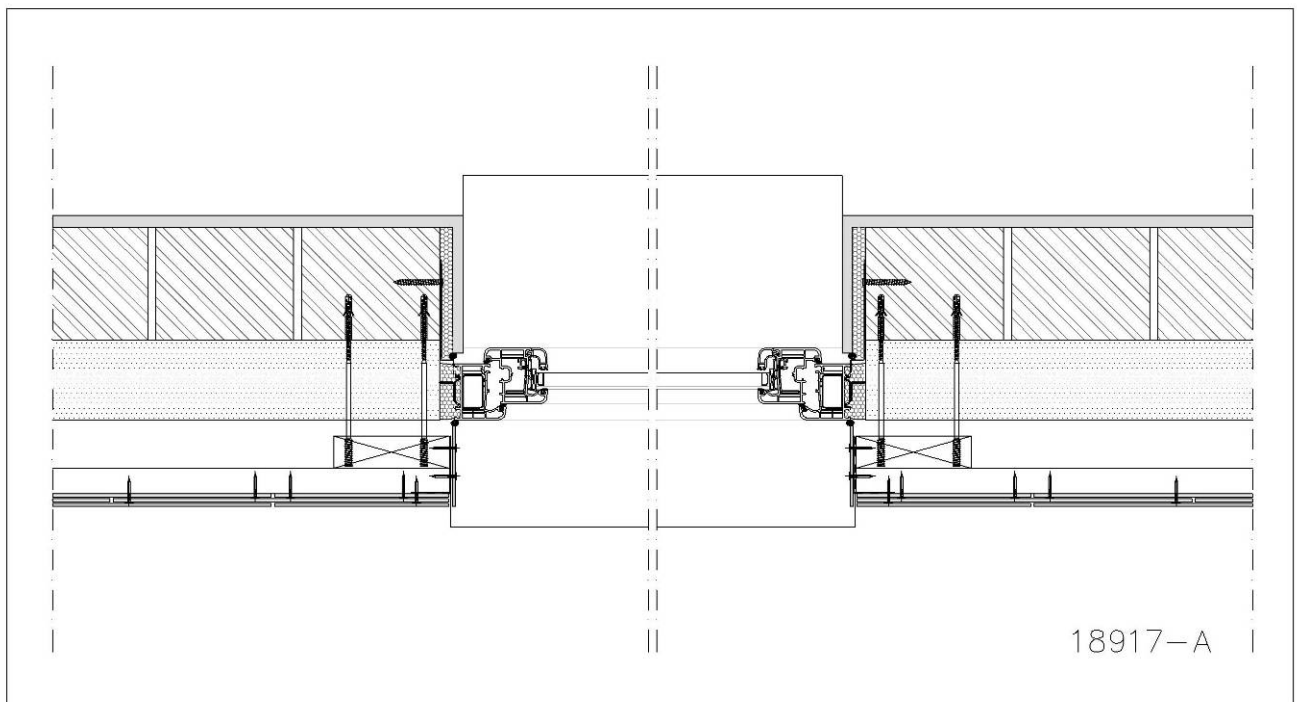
Voorbeeld inspringend raam (met dagkant) – klassieke afwerking – horizontale doorsnede
